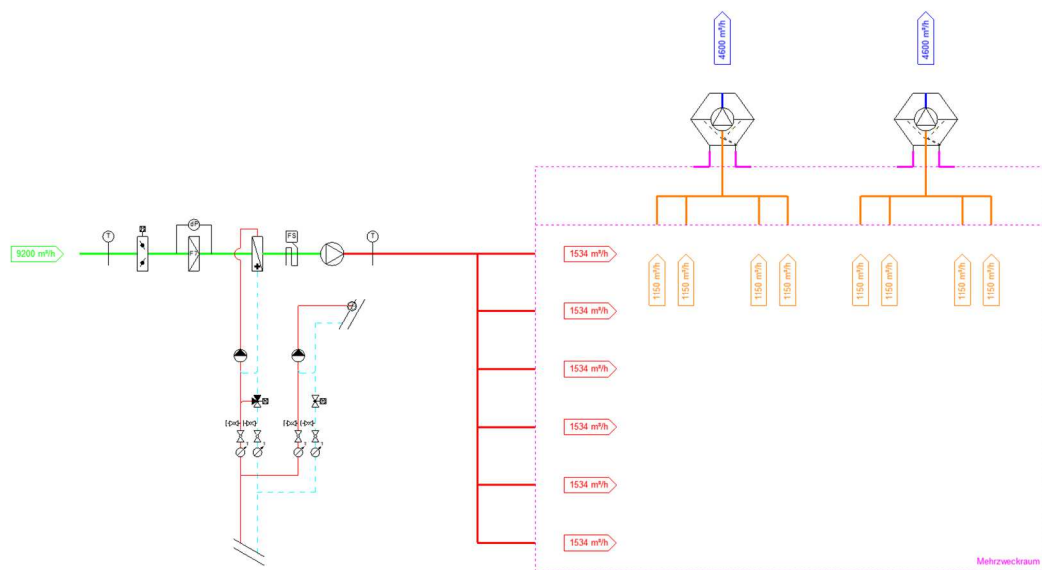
Schema Bestand LA01 - Mehrzweckhalle
